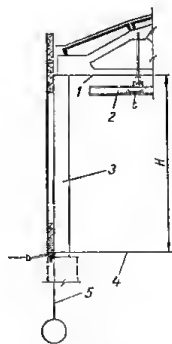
Высота зданий с подвесными кранами или без кранов при внутреннем отводе воды:
